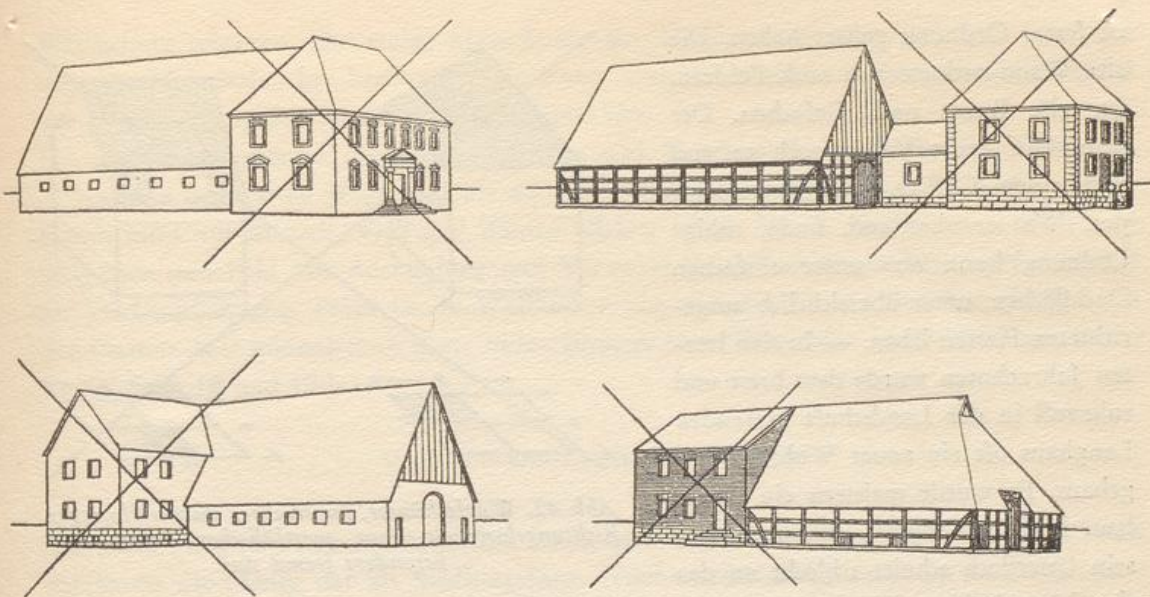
Alte langfirstige Bauernhäuser durch An- und Aufbau verdorben
